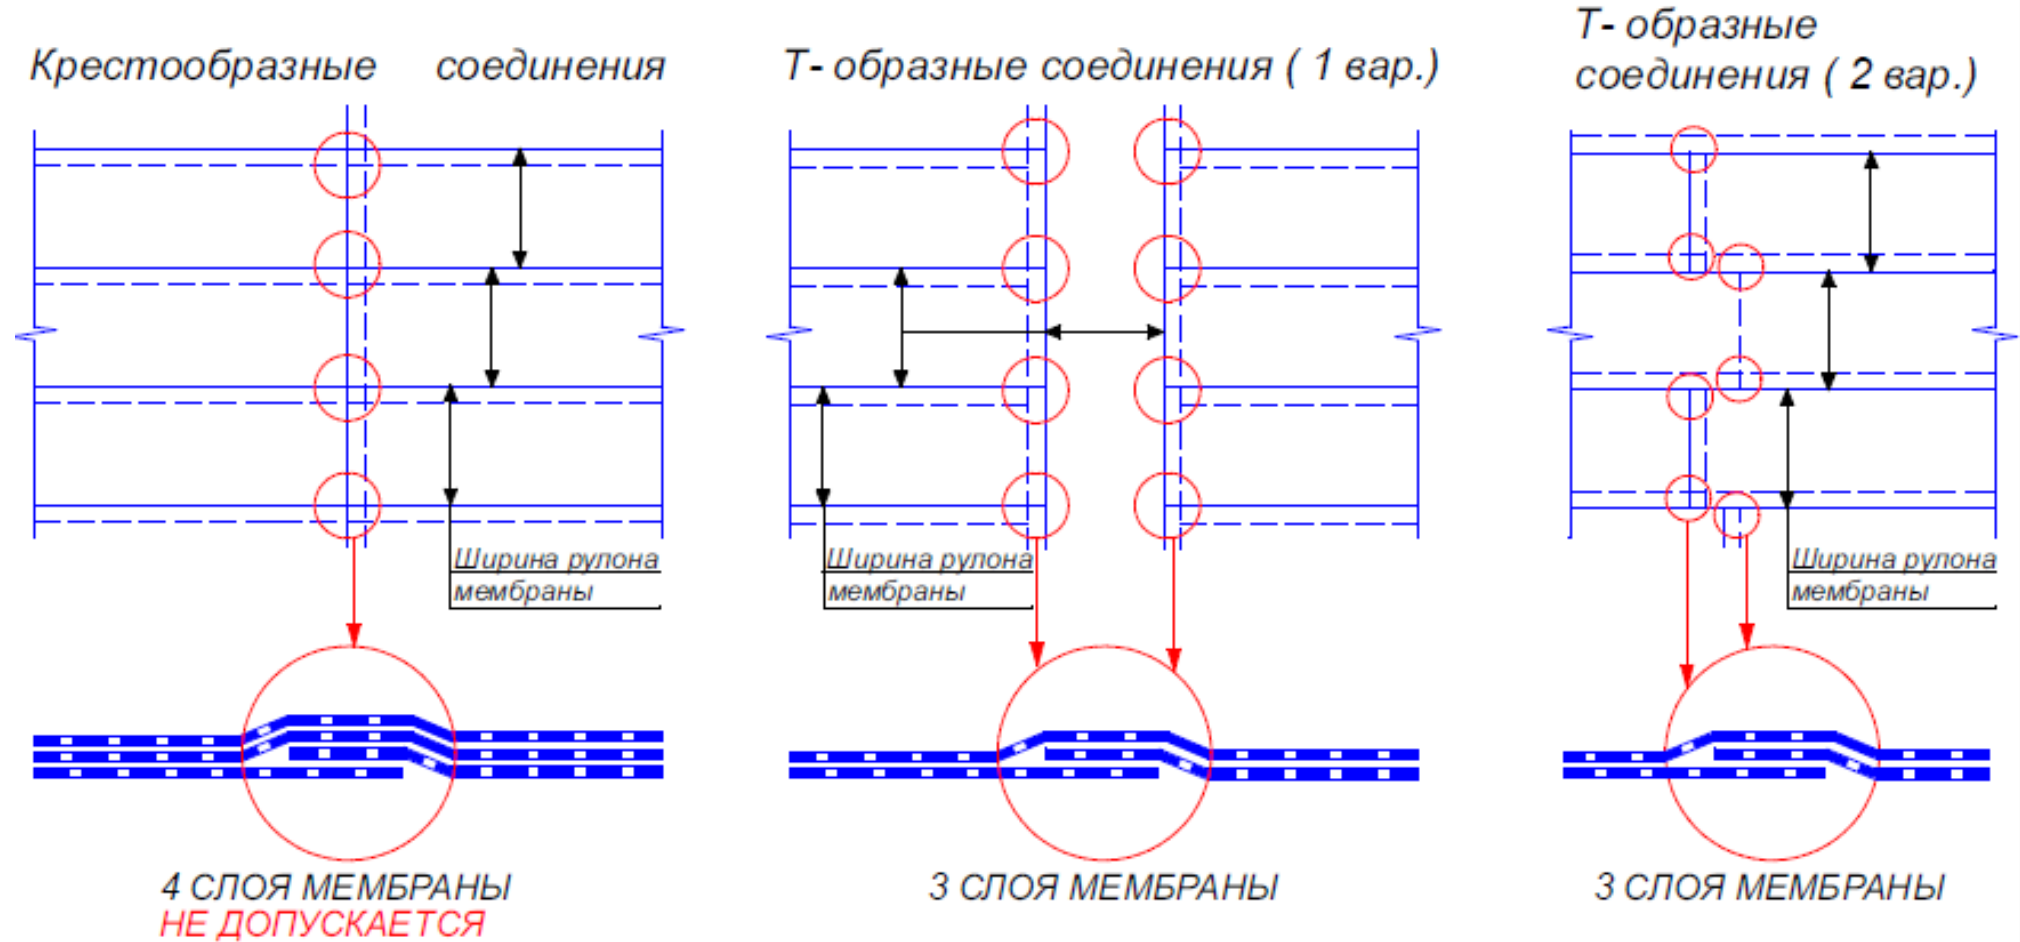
Возможные схемы раскладки рулонов гидроизоляционных мембран.
